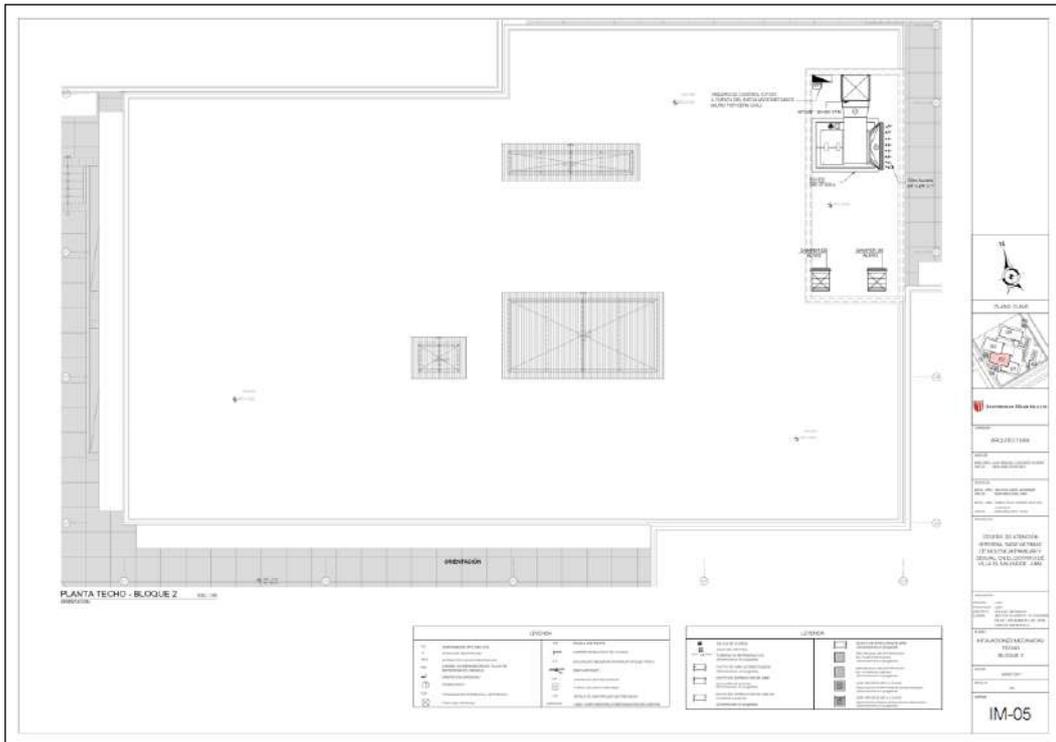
Planta de azotea de instalaciones mecánicas – bloque 2.
